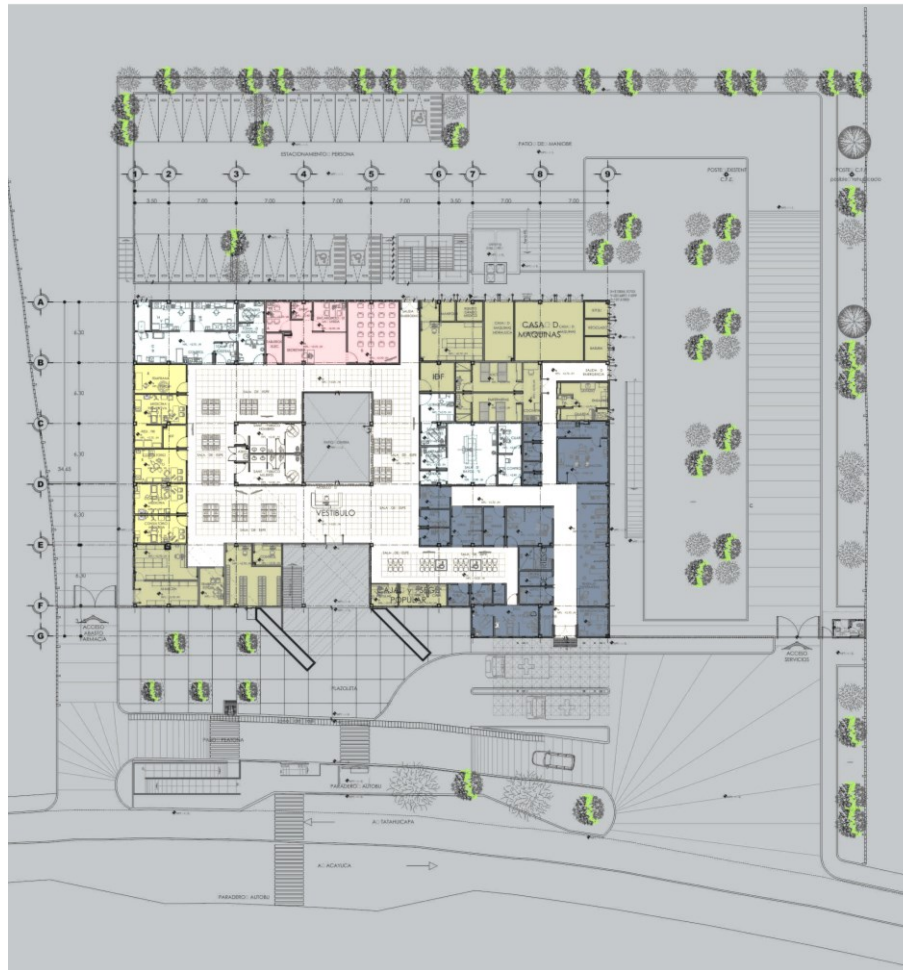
Planta Arquitectónica de Centro de Salud de Servicios Adicionales (CESSA)
